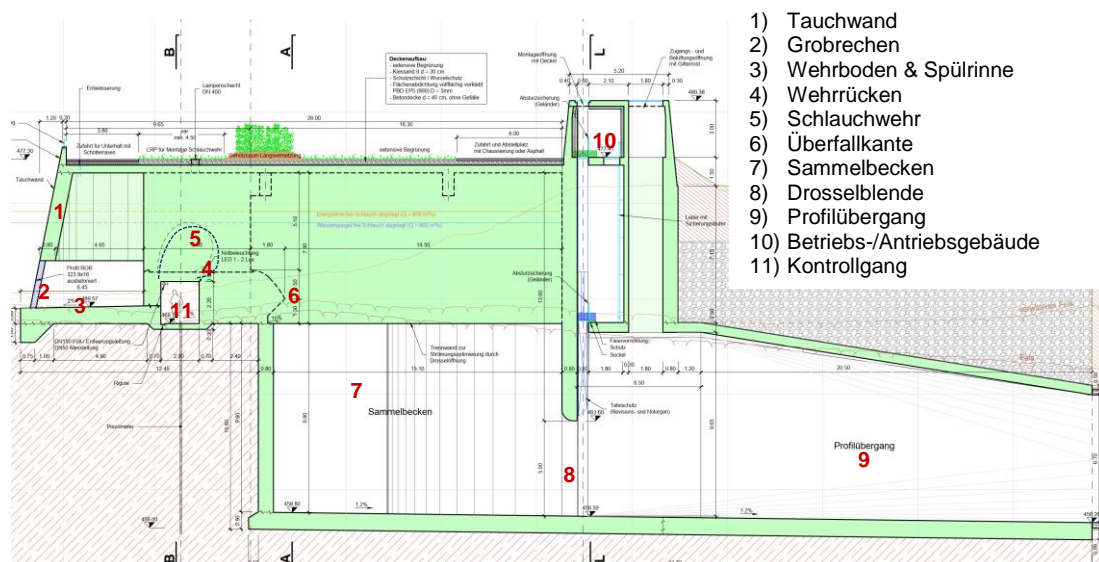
Längsschnitt durch das Einlaufbauwerk mit entsprechenden Anlagenteilen
